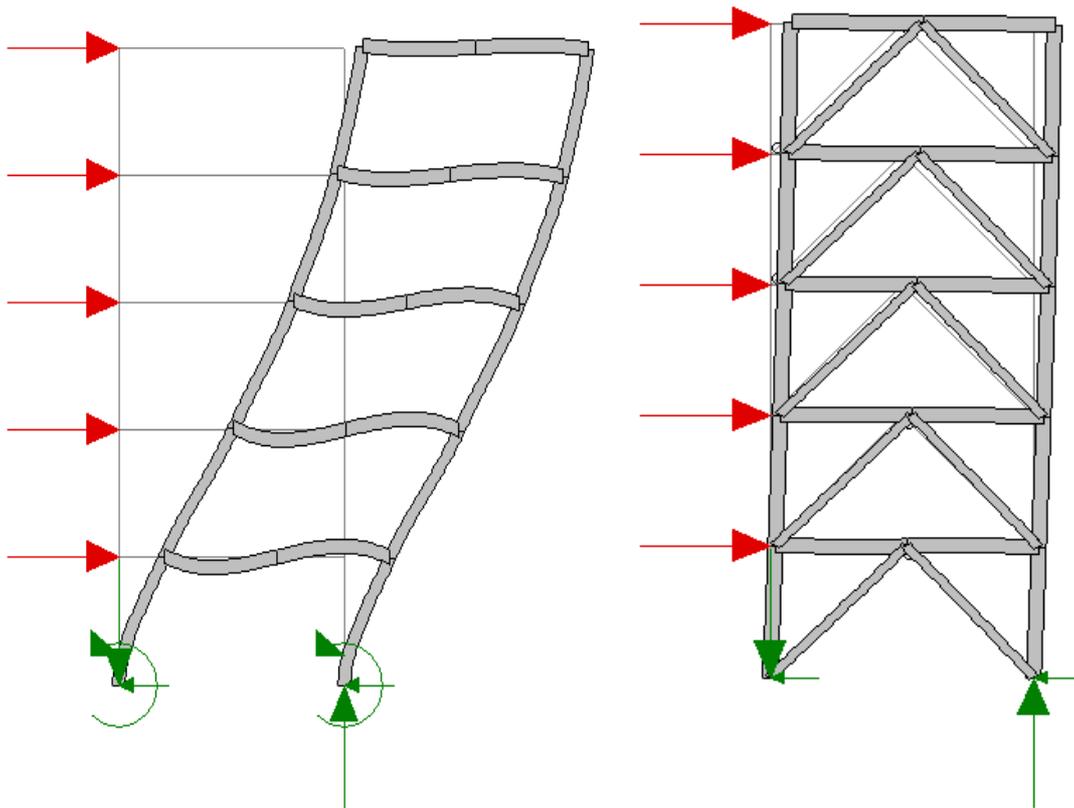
Travamento realizado pelo contraventamento [7]
